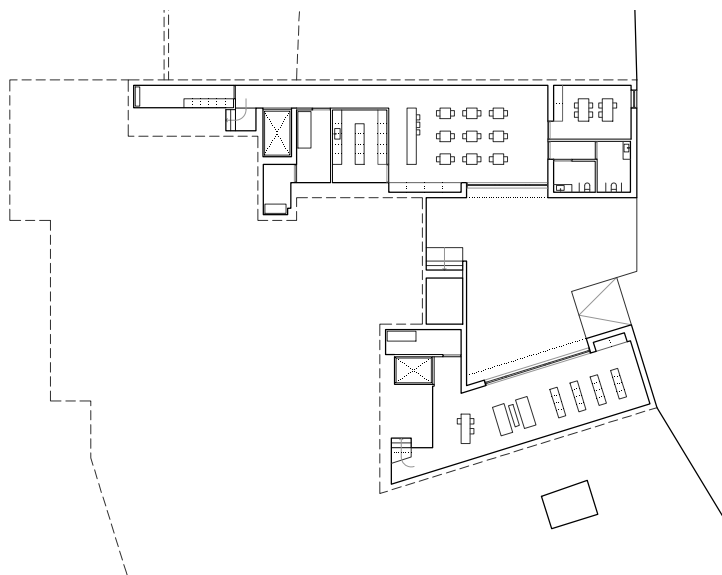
Planta baja del Módulo 2 y 3. Escala 1/500.
